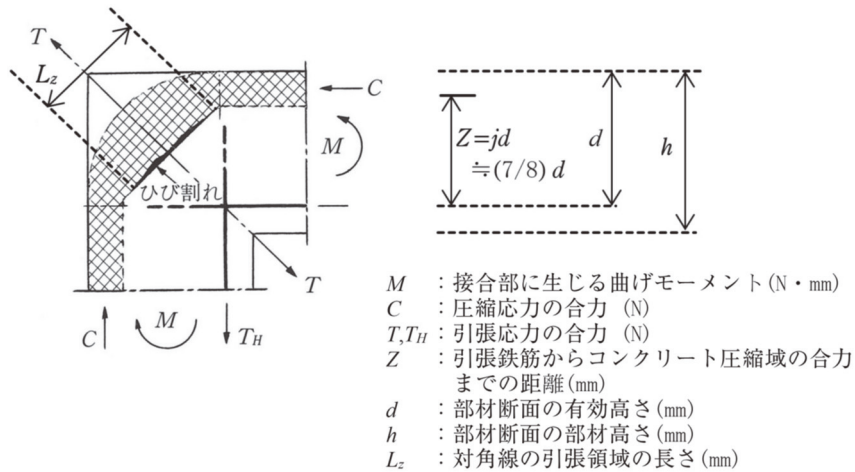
内側引張の曲げモーメントによる接合部のひび割れ
